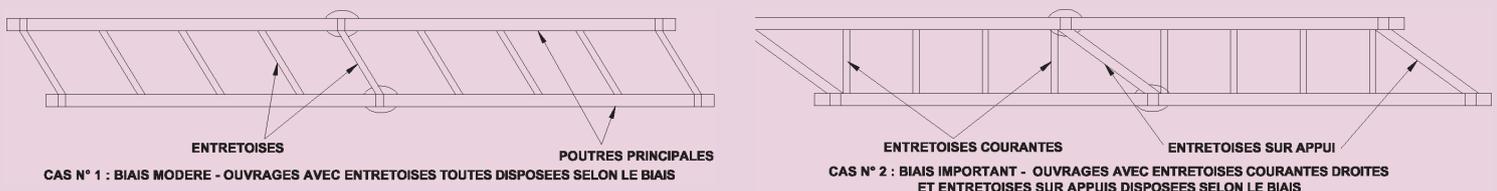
Principe de disposition des entretoises sur les tabliers bipoutres biais (modéré et important)
